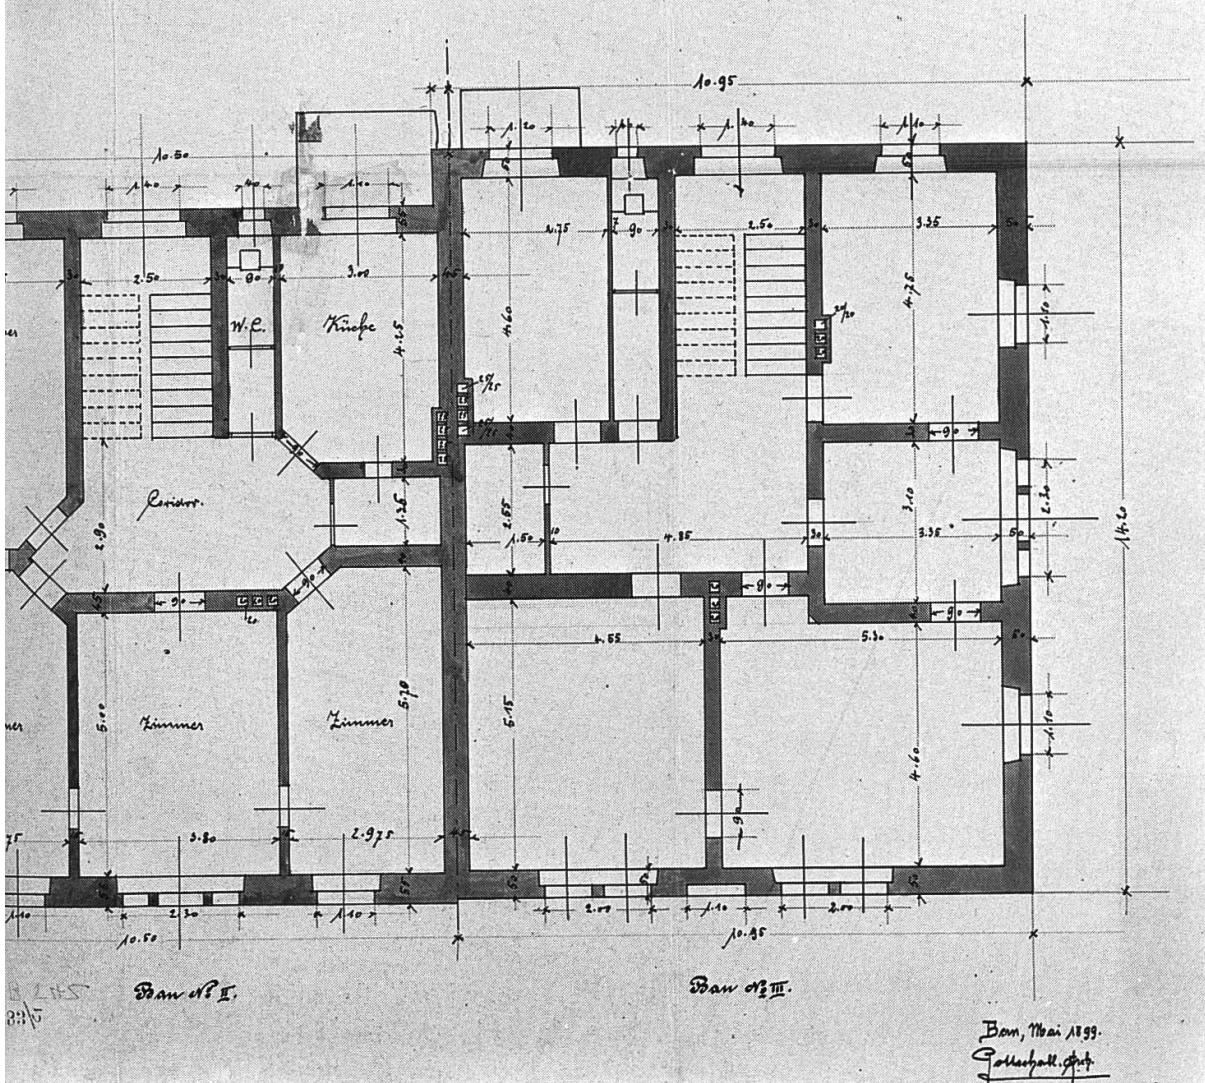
Falkenplatz 22-24 / Hallerstrasse 1. Grundriss der Obergeschosse von 1899.
